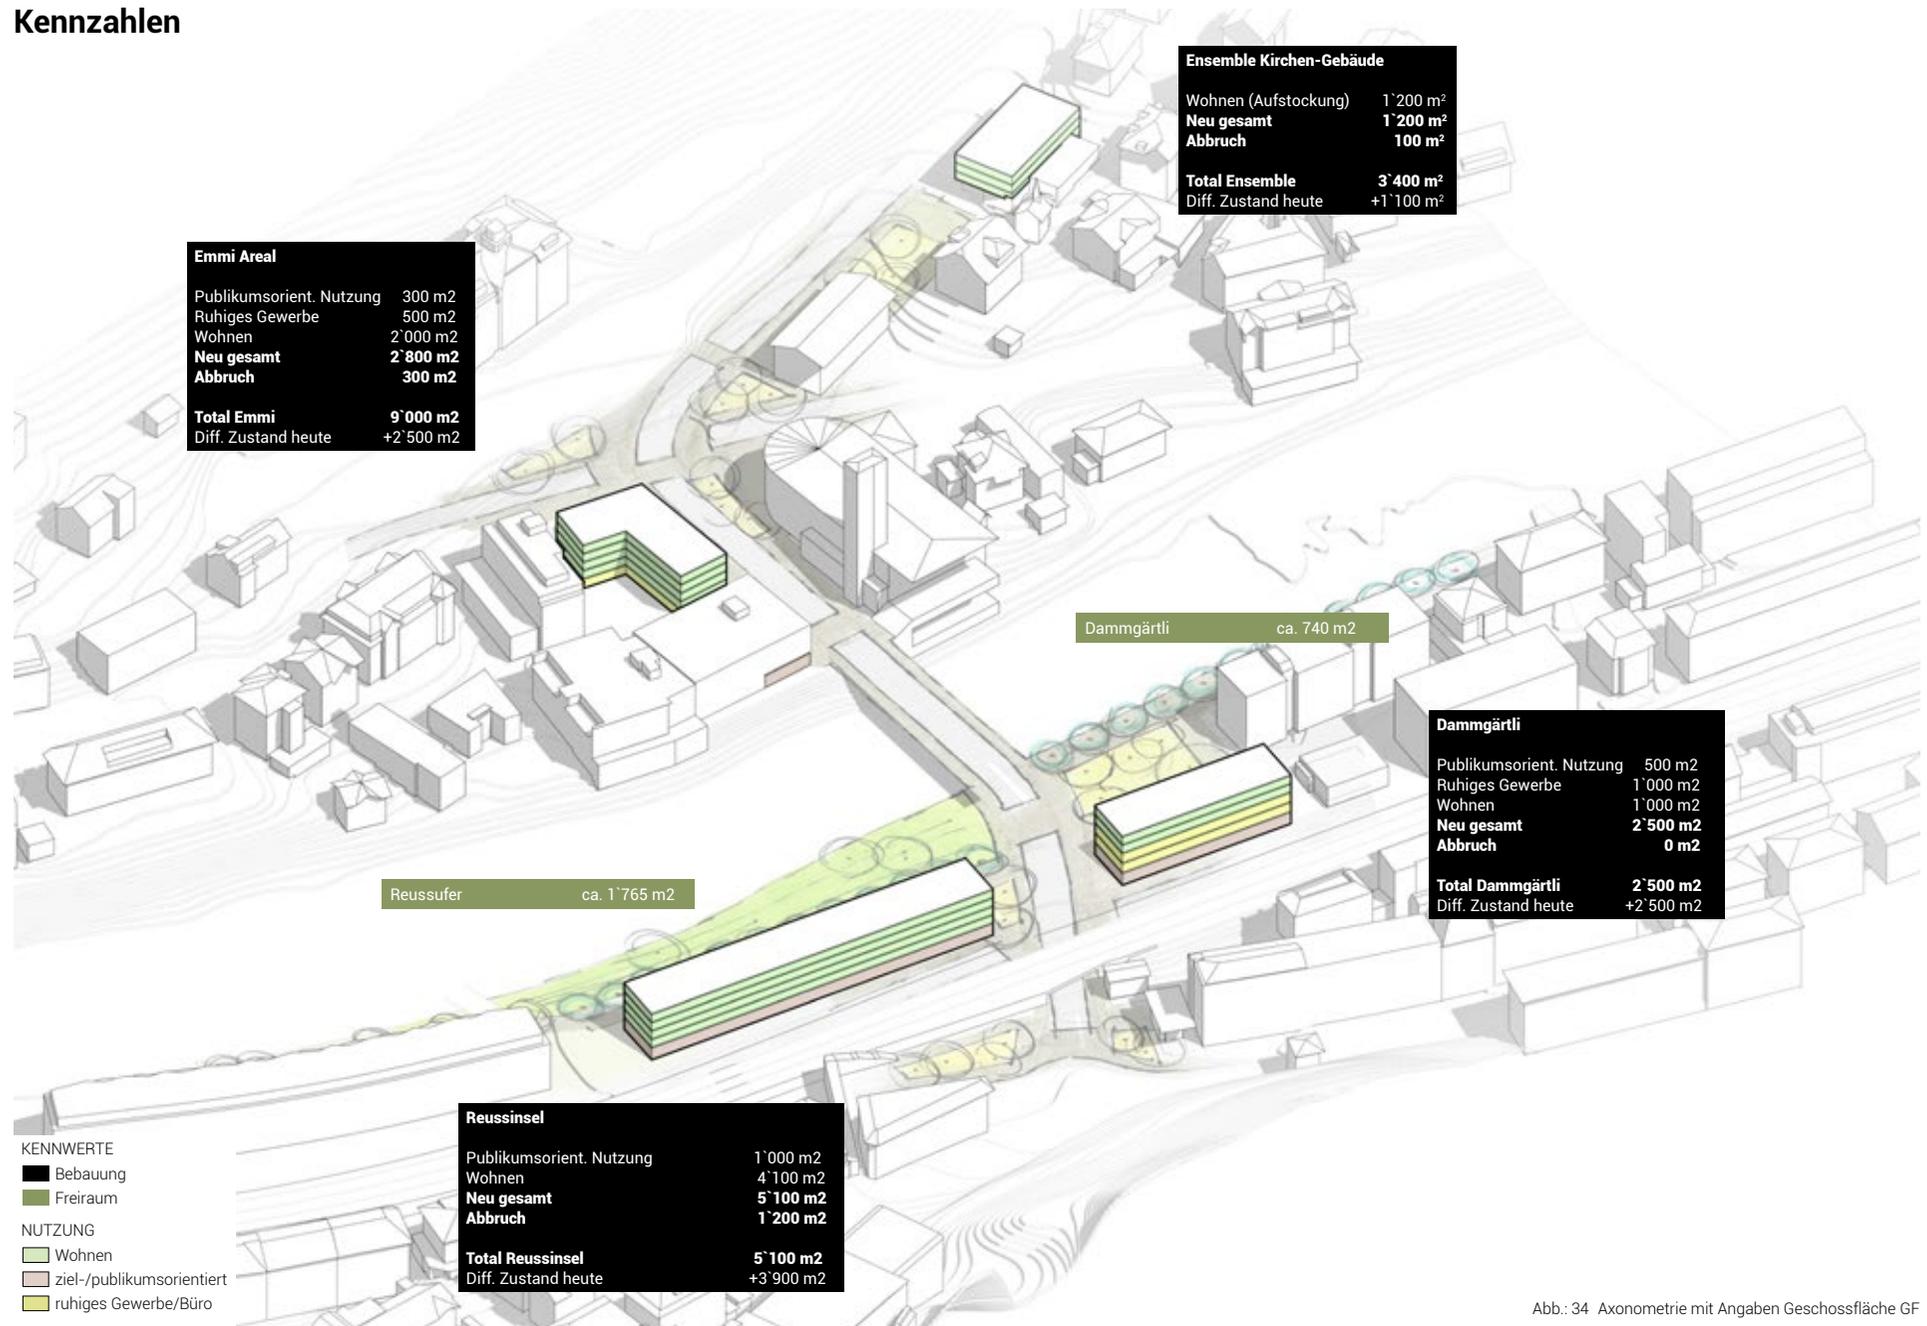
Axonometrie mit Angaben Geschossfläche GF
